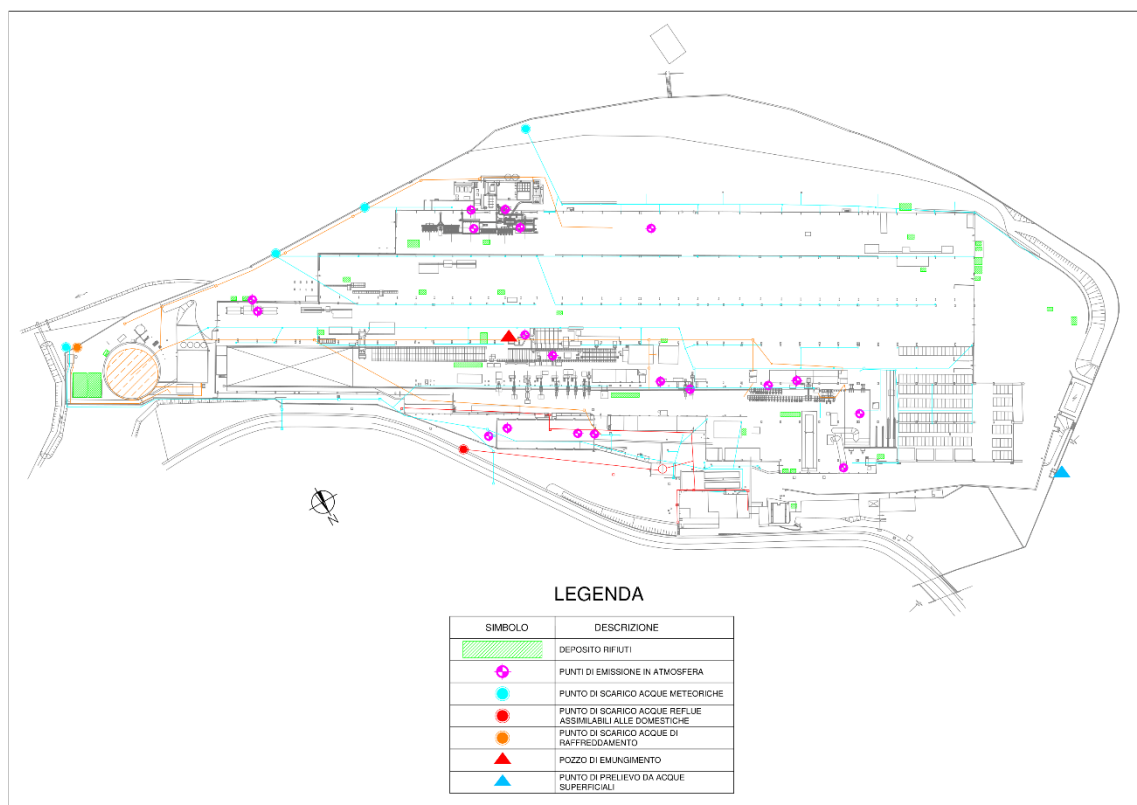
Planimetria del sito Acciaierie Venete S.p.A. di Mura (BS)
